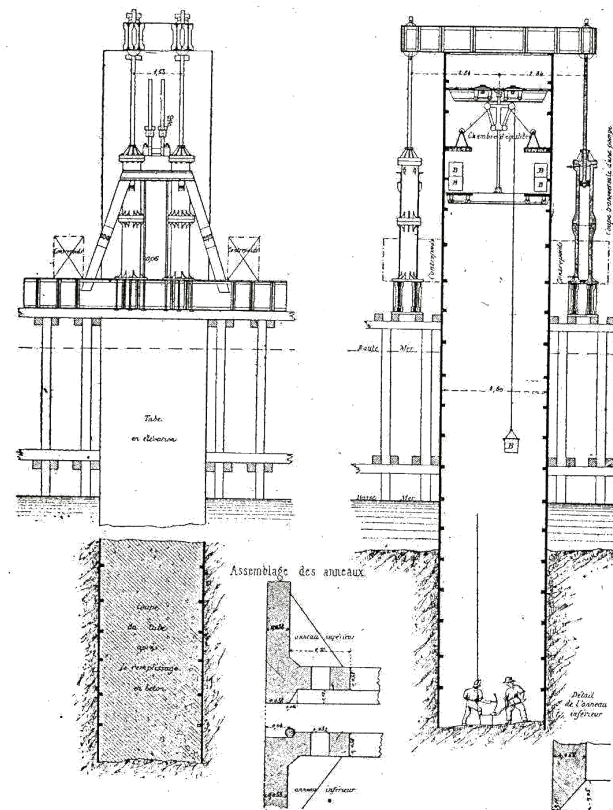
Fondations du pont sur la Garonne, à Bordeaux.
